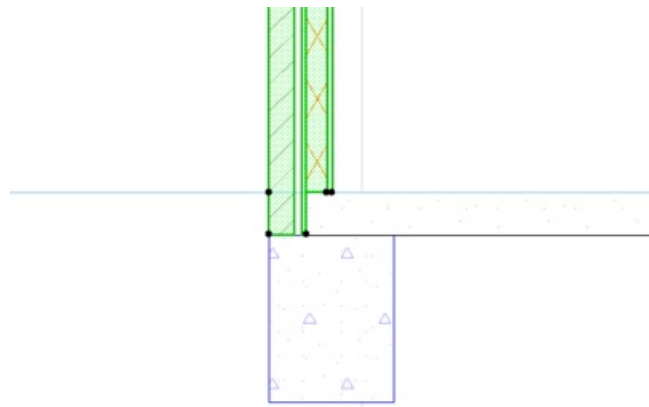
Вузол перекриття-фундамент-багатошарова стіна
